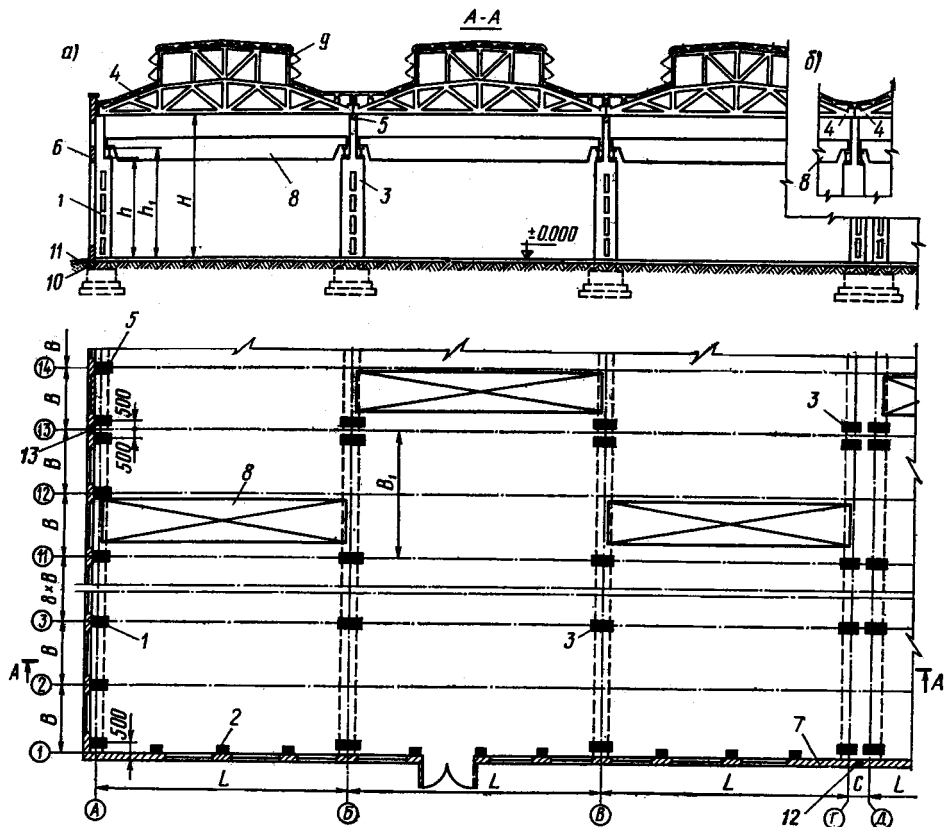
Одноповерхова виробнича будівля із збірного залізобетону.
